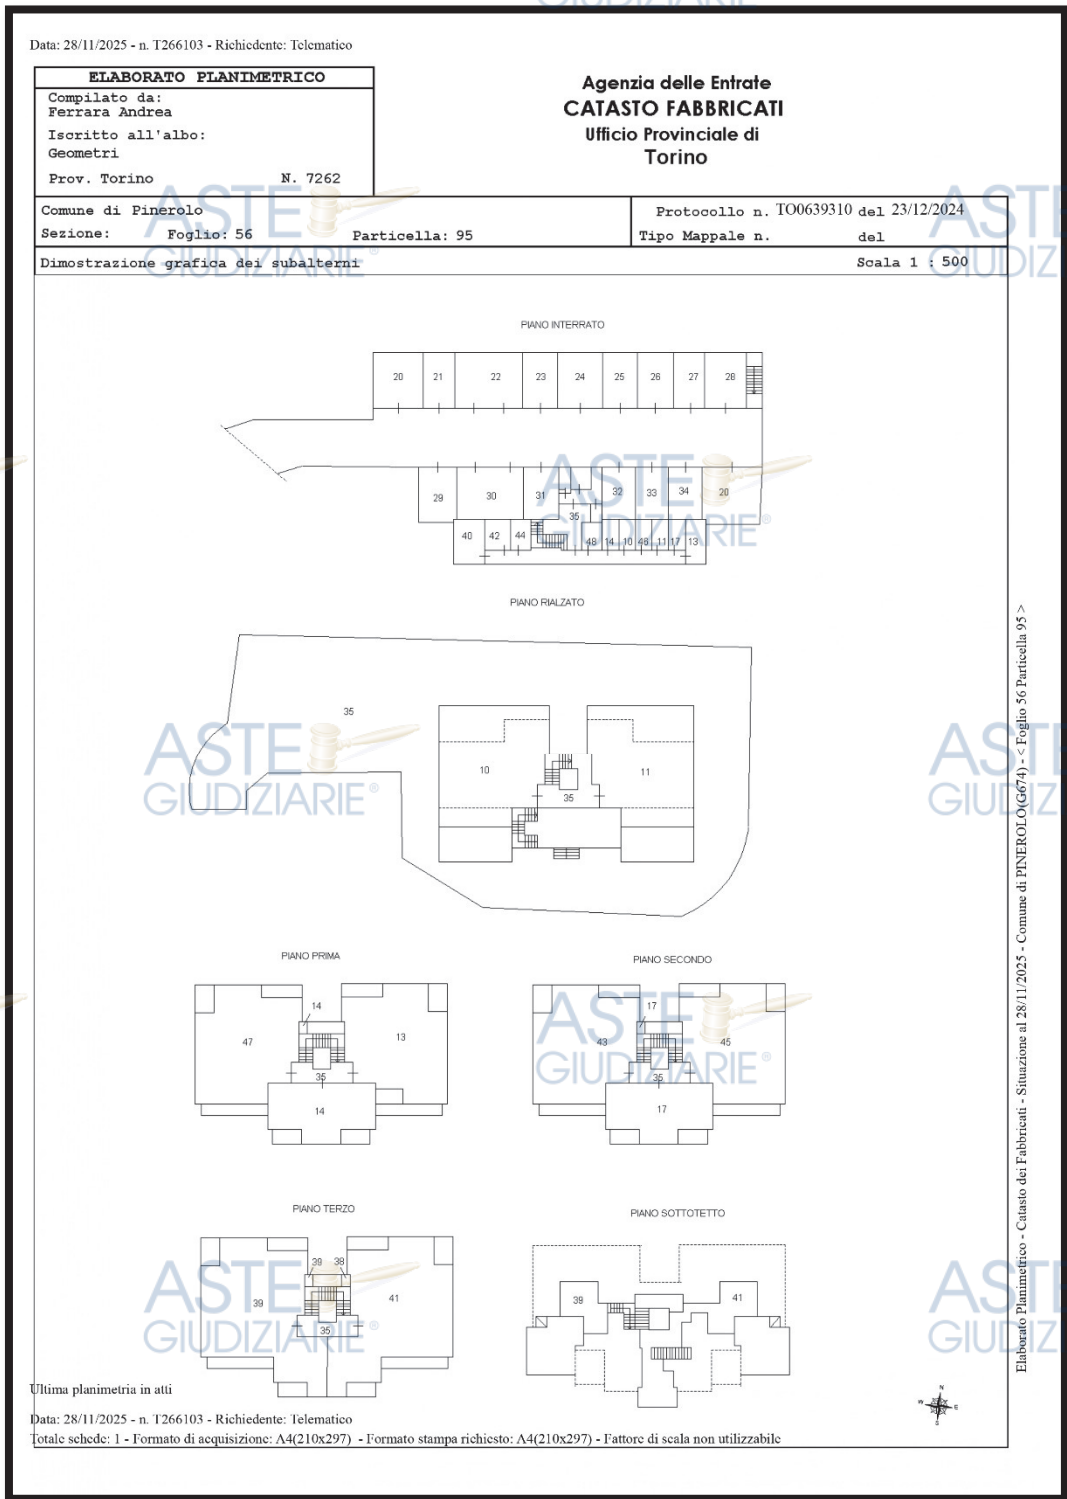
Elaborato planimetrico prof. n. TO0639310
